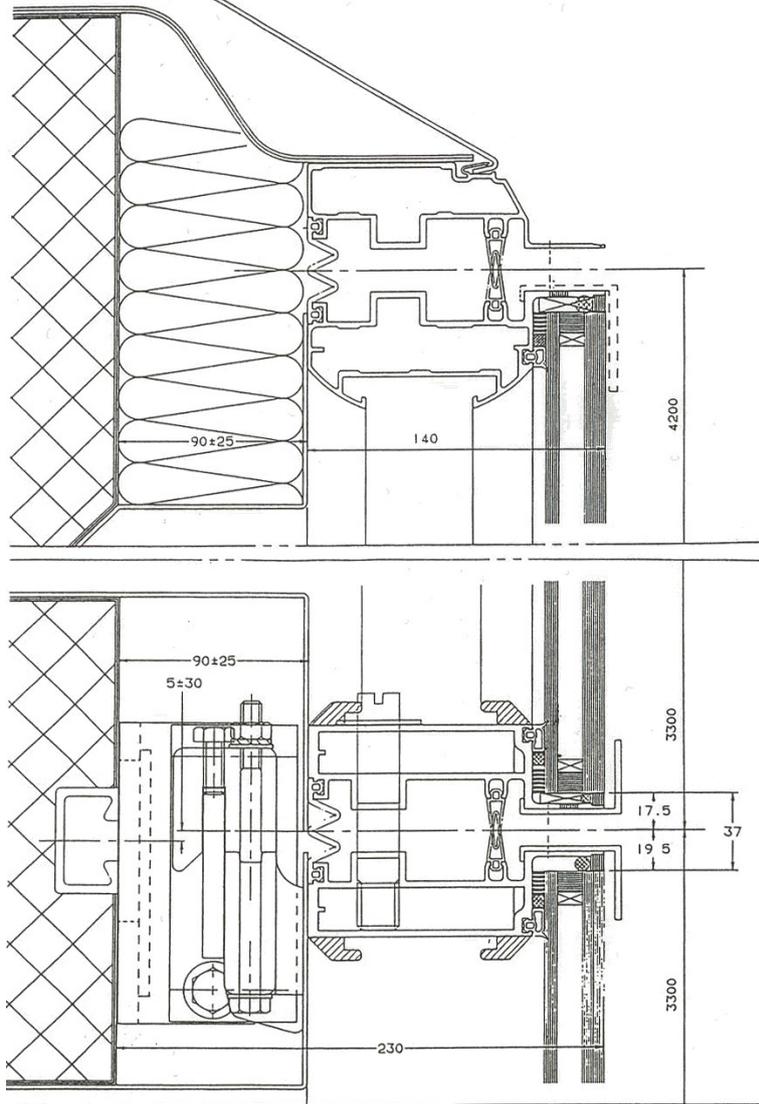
Hotel Industrial Berlier, Detalles de la carpintería de fachada.
